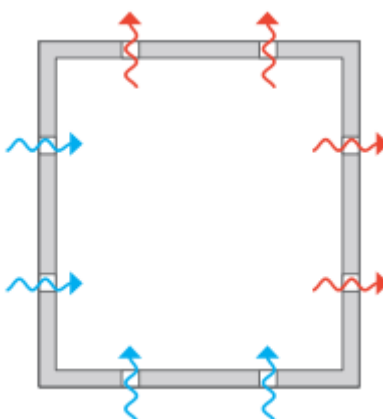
Distribución de aberturas en planta. Fuente: [27].
